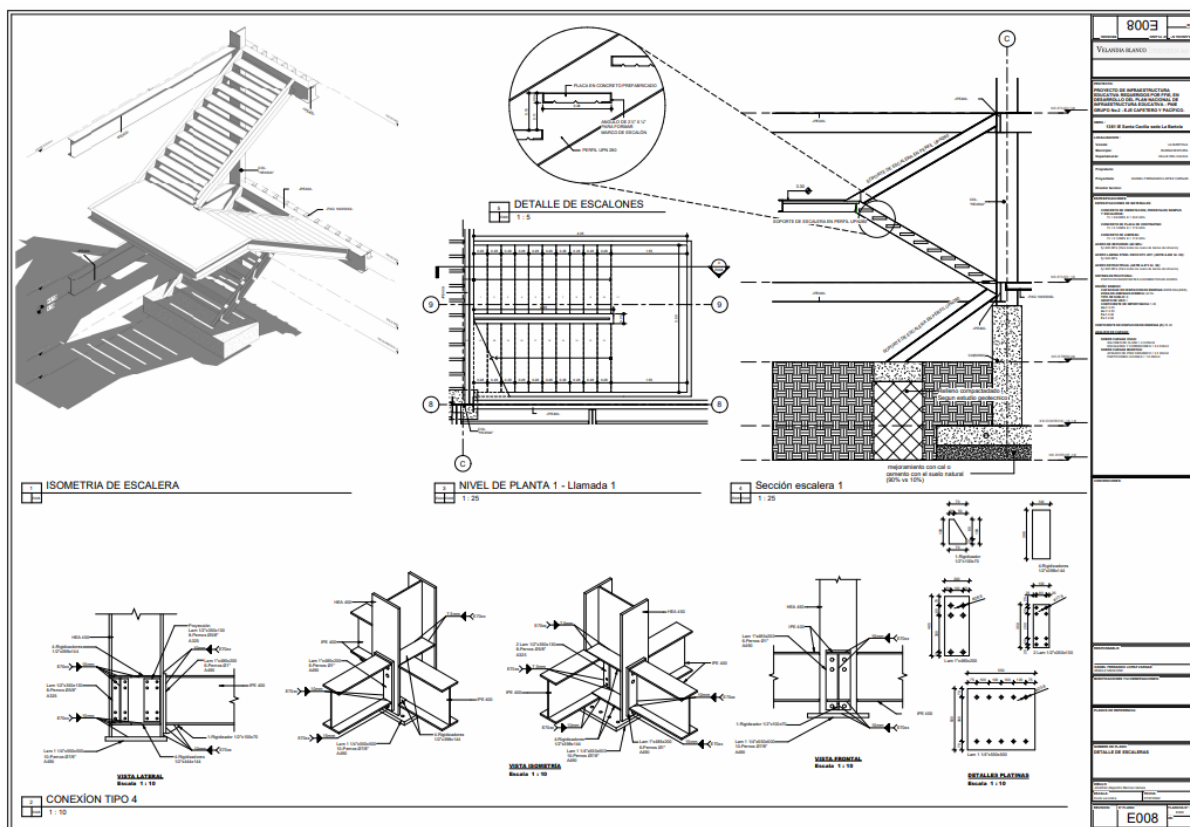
Detalles de escaleras y conexiones metálicas. (fuente: propia).
